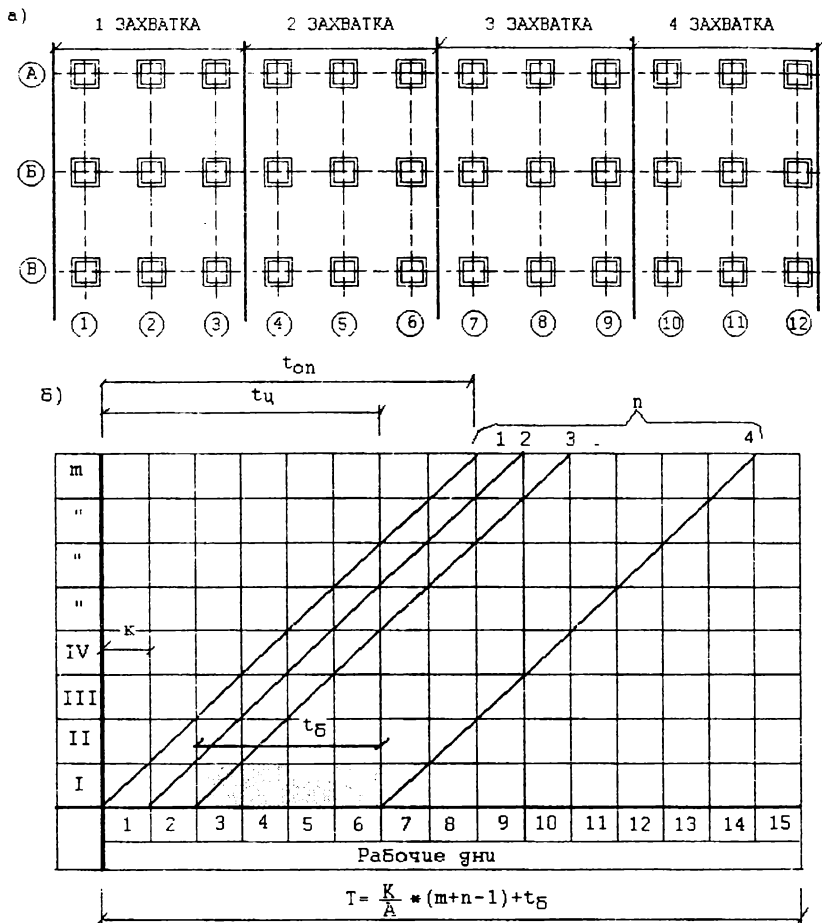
Поточная организация процесса бетонирования железобетонных фундаментов.
